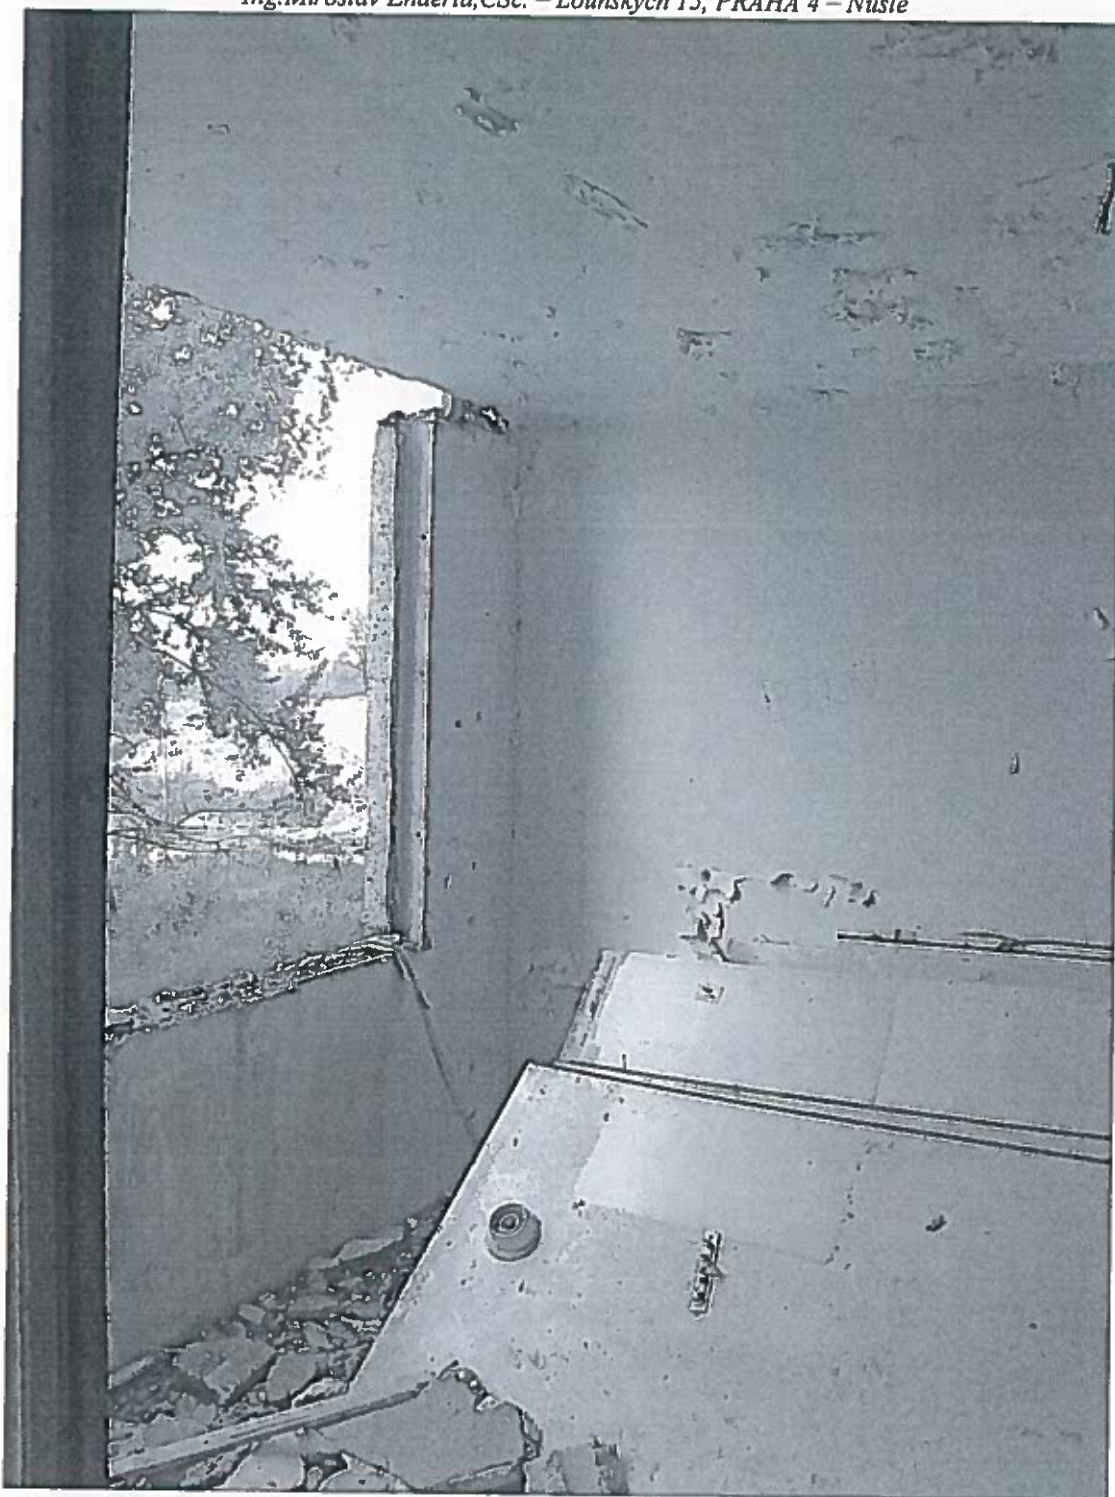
Stropní konstrukce nad 2.NP zůstala bez poškození
